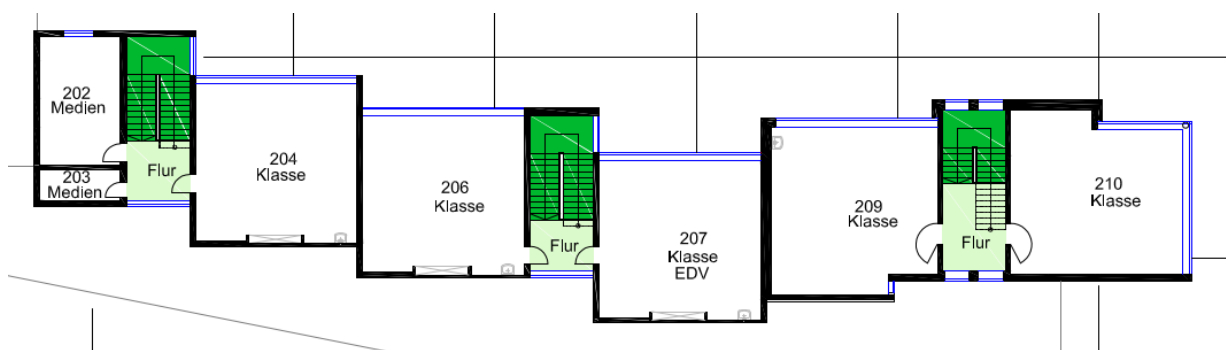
Separierte Bereiche im Obergeschoss des Gebäudeteil 3
